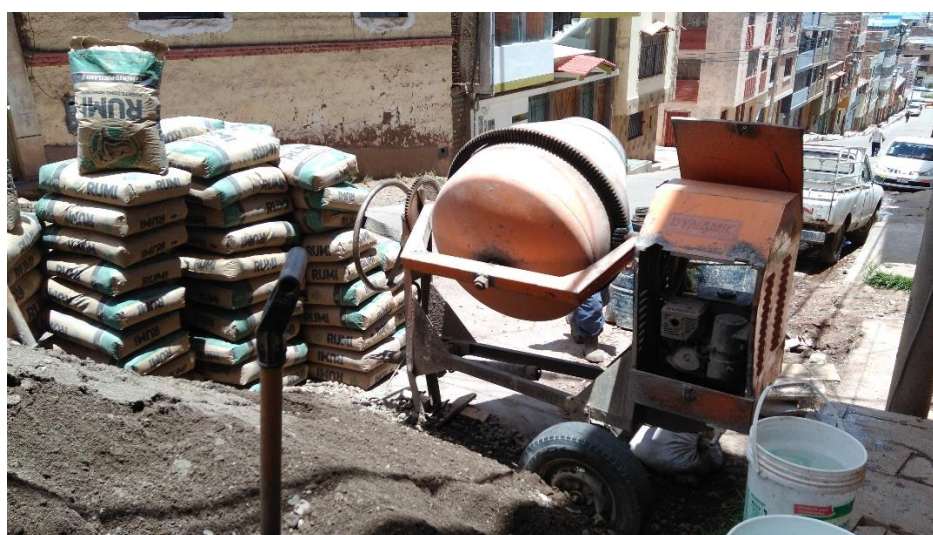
Vista frontal de la construcción, vivienda número 09.
